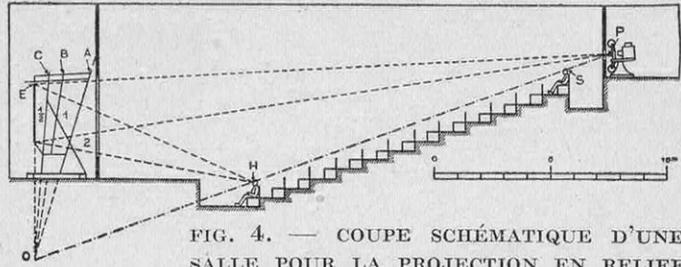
COUPE SCHEMATIQUE D'UNE SALLE POUR LA PROJECTION EN RELIEF
